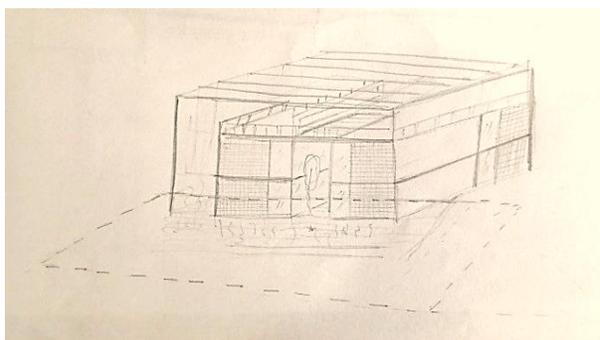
Bloques Aulas E.I., Elevación Sur
